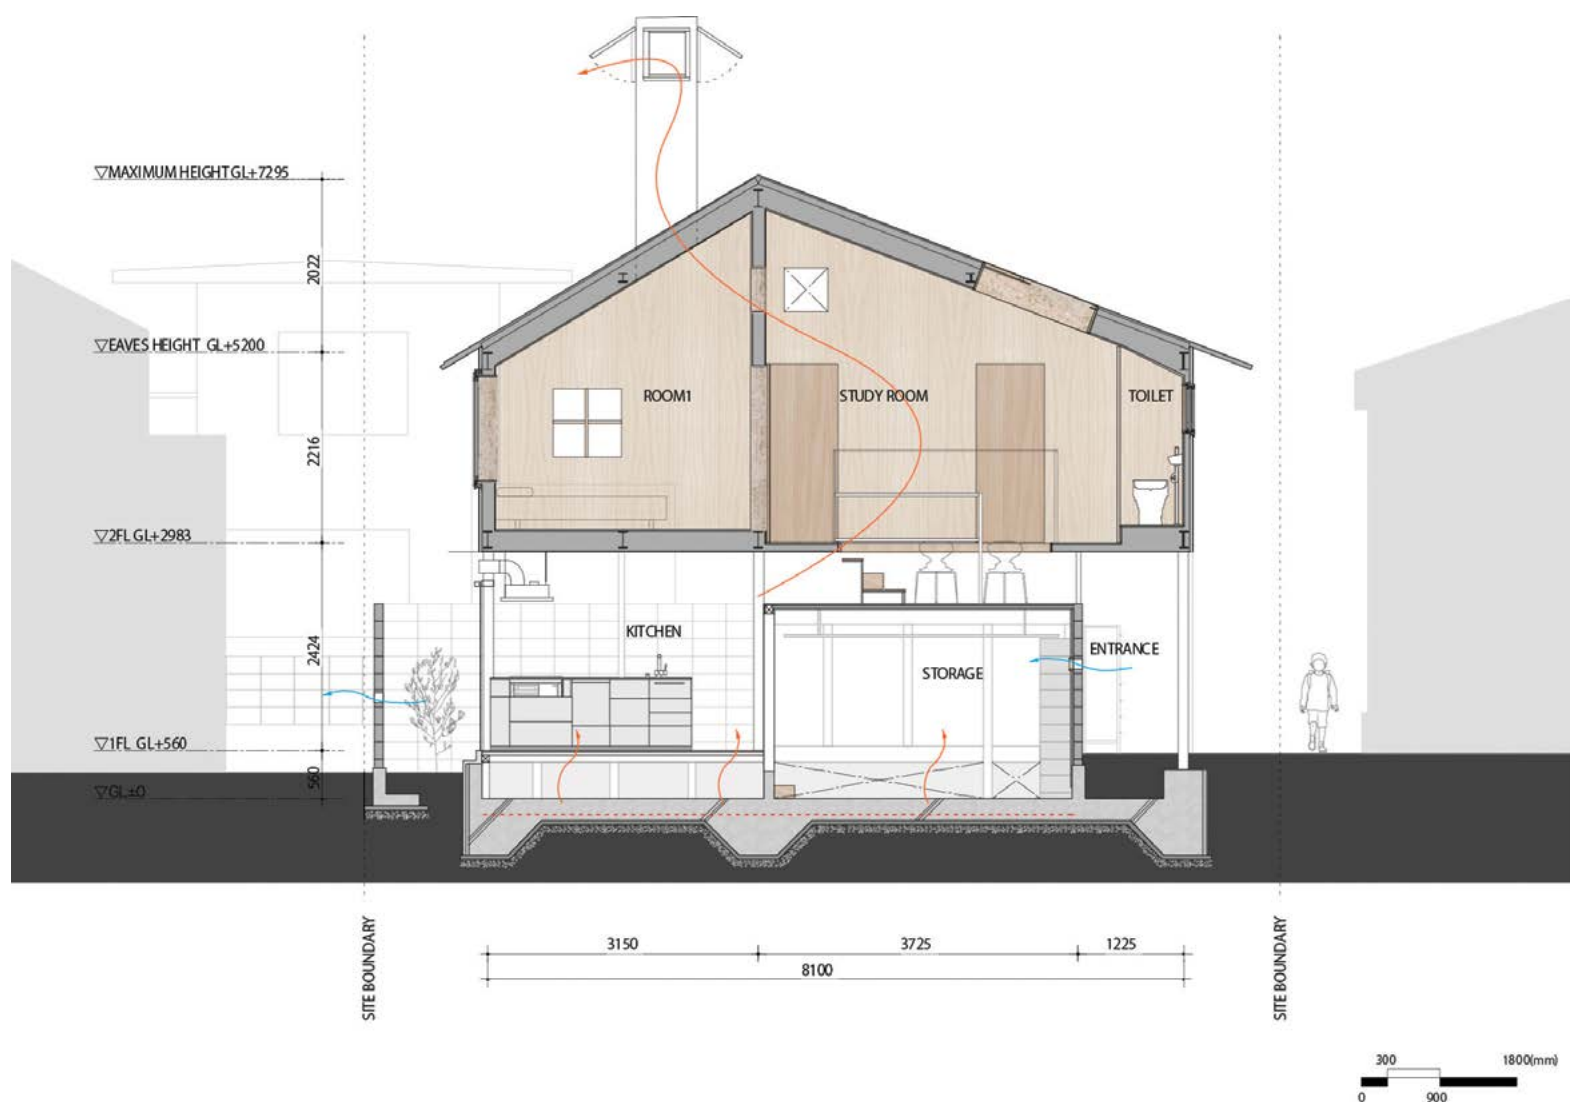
Casa a Kawanishi - Sezione trasversale dell'edificio
